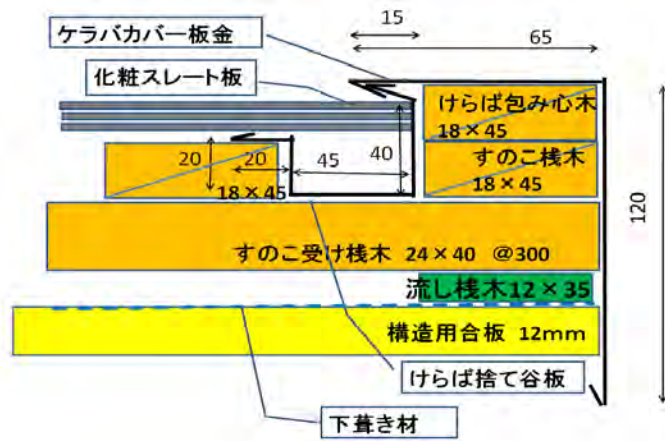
けらば部 断面図例 (図中の数字の単位は mm)
